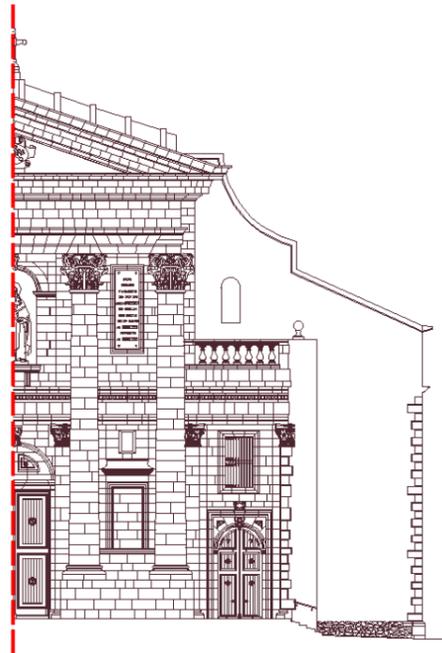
Eje de simetría de la Fachada de St. Antonio
